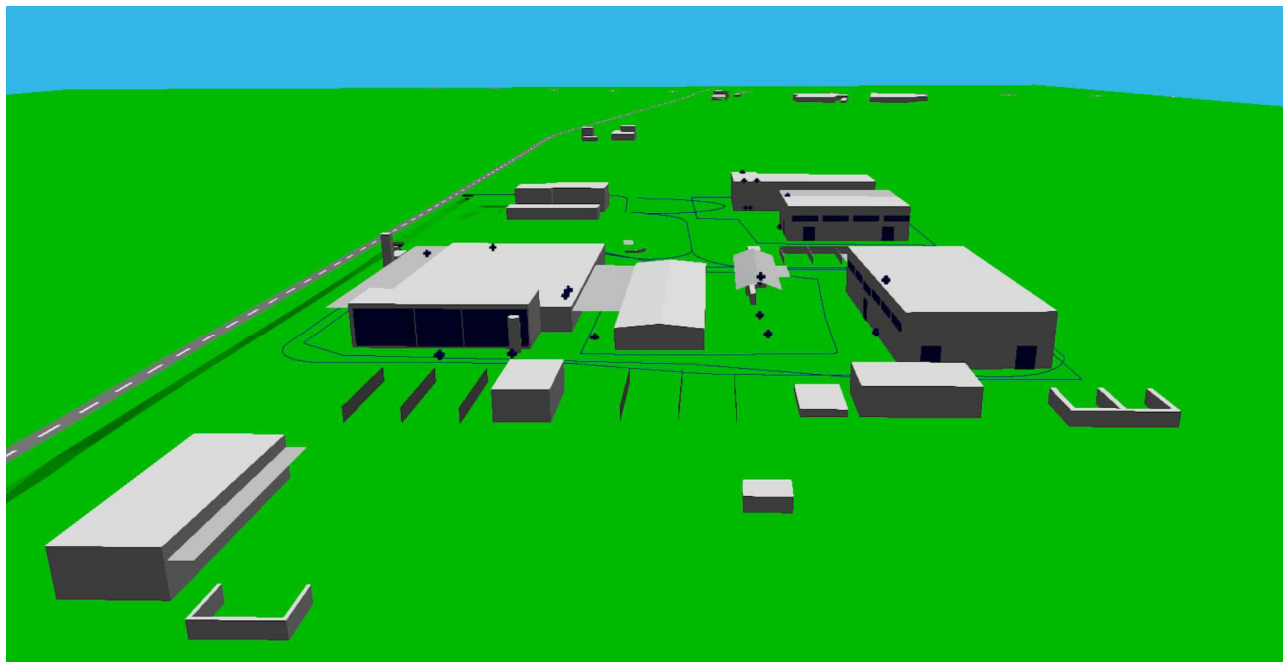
Modello 3D dell'area - stato di progetto - vista Nord - dettaglio Tred
